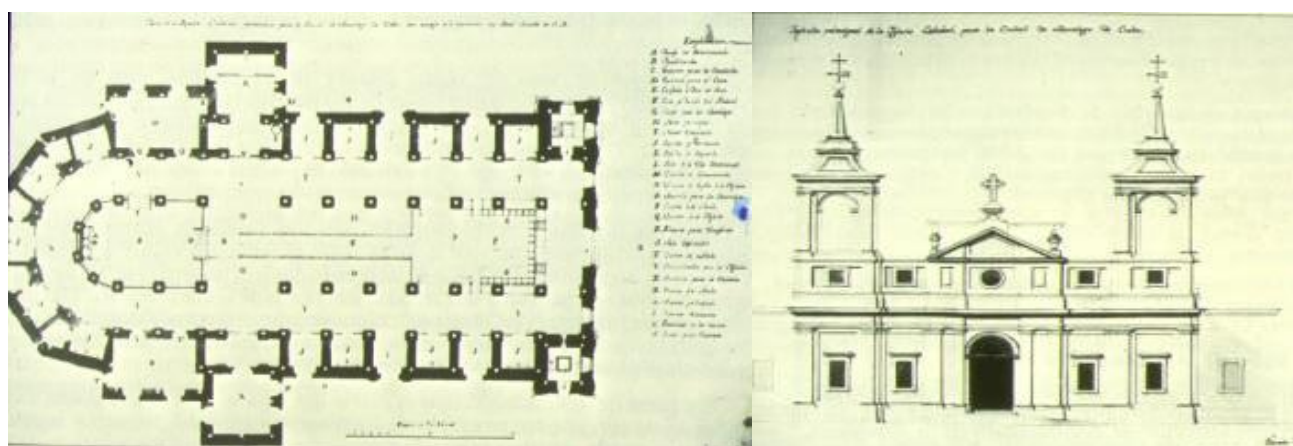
Planta y Alzado del Proyecto de Manuel Martín Rodríguez. 1978. Fuente: OCC.
